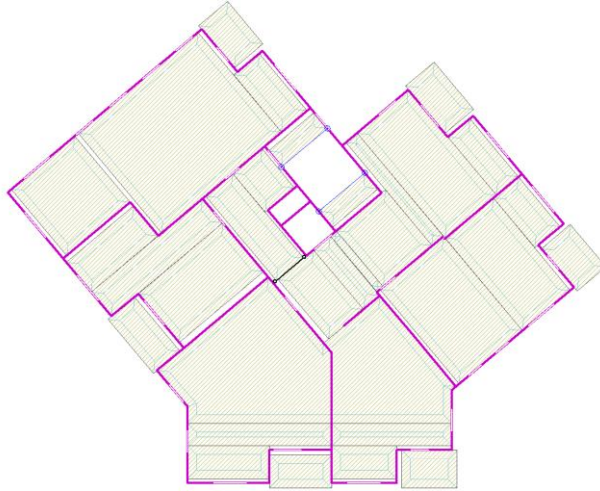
Загальний вигляд розрахункової схеми 2-го поверху
